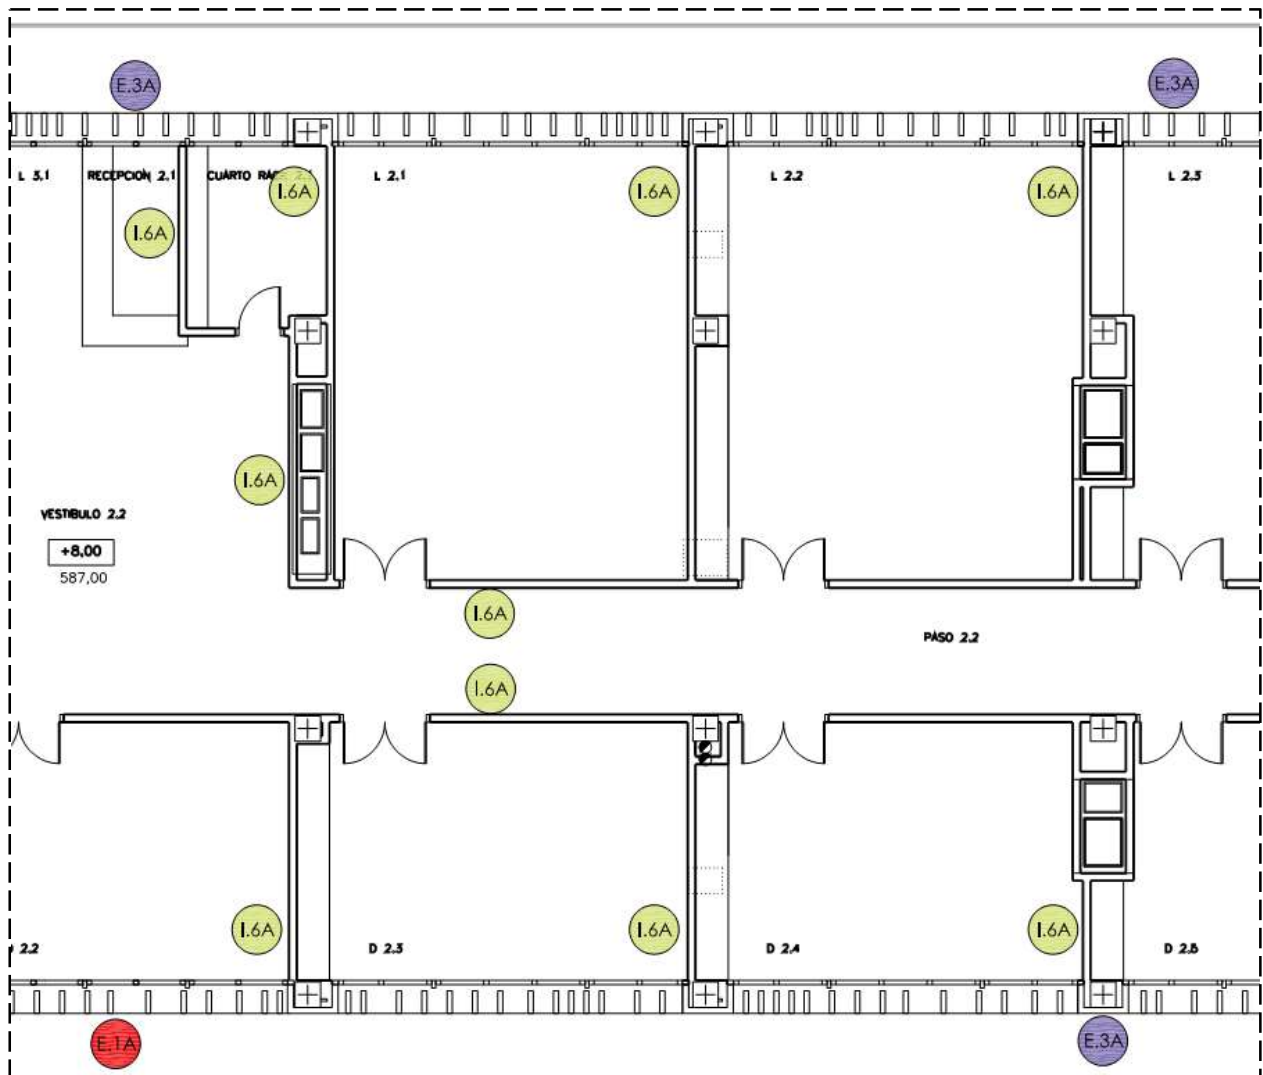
Detalle del plano de Particiones Interiores Planta 2ª. RP-6 (m1)
